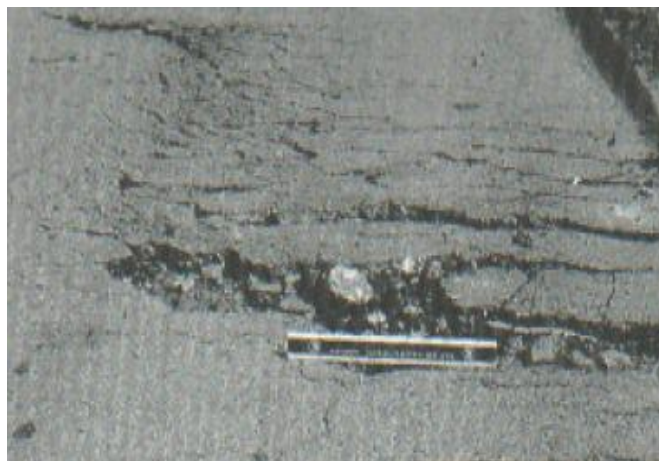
Fisuras parabólicas -Baja severidad.
